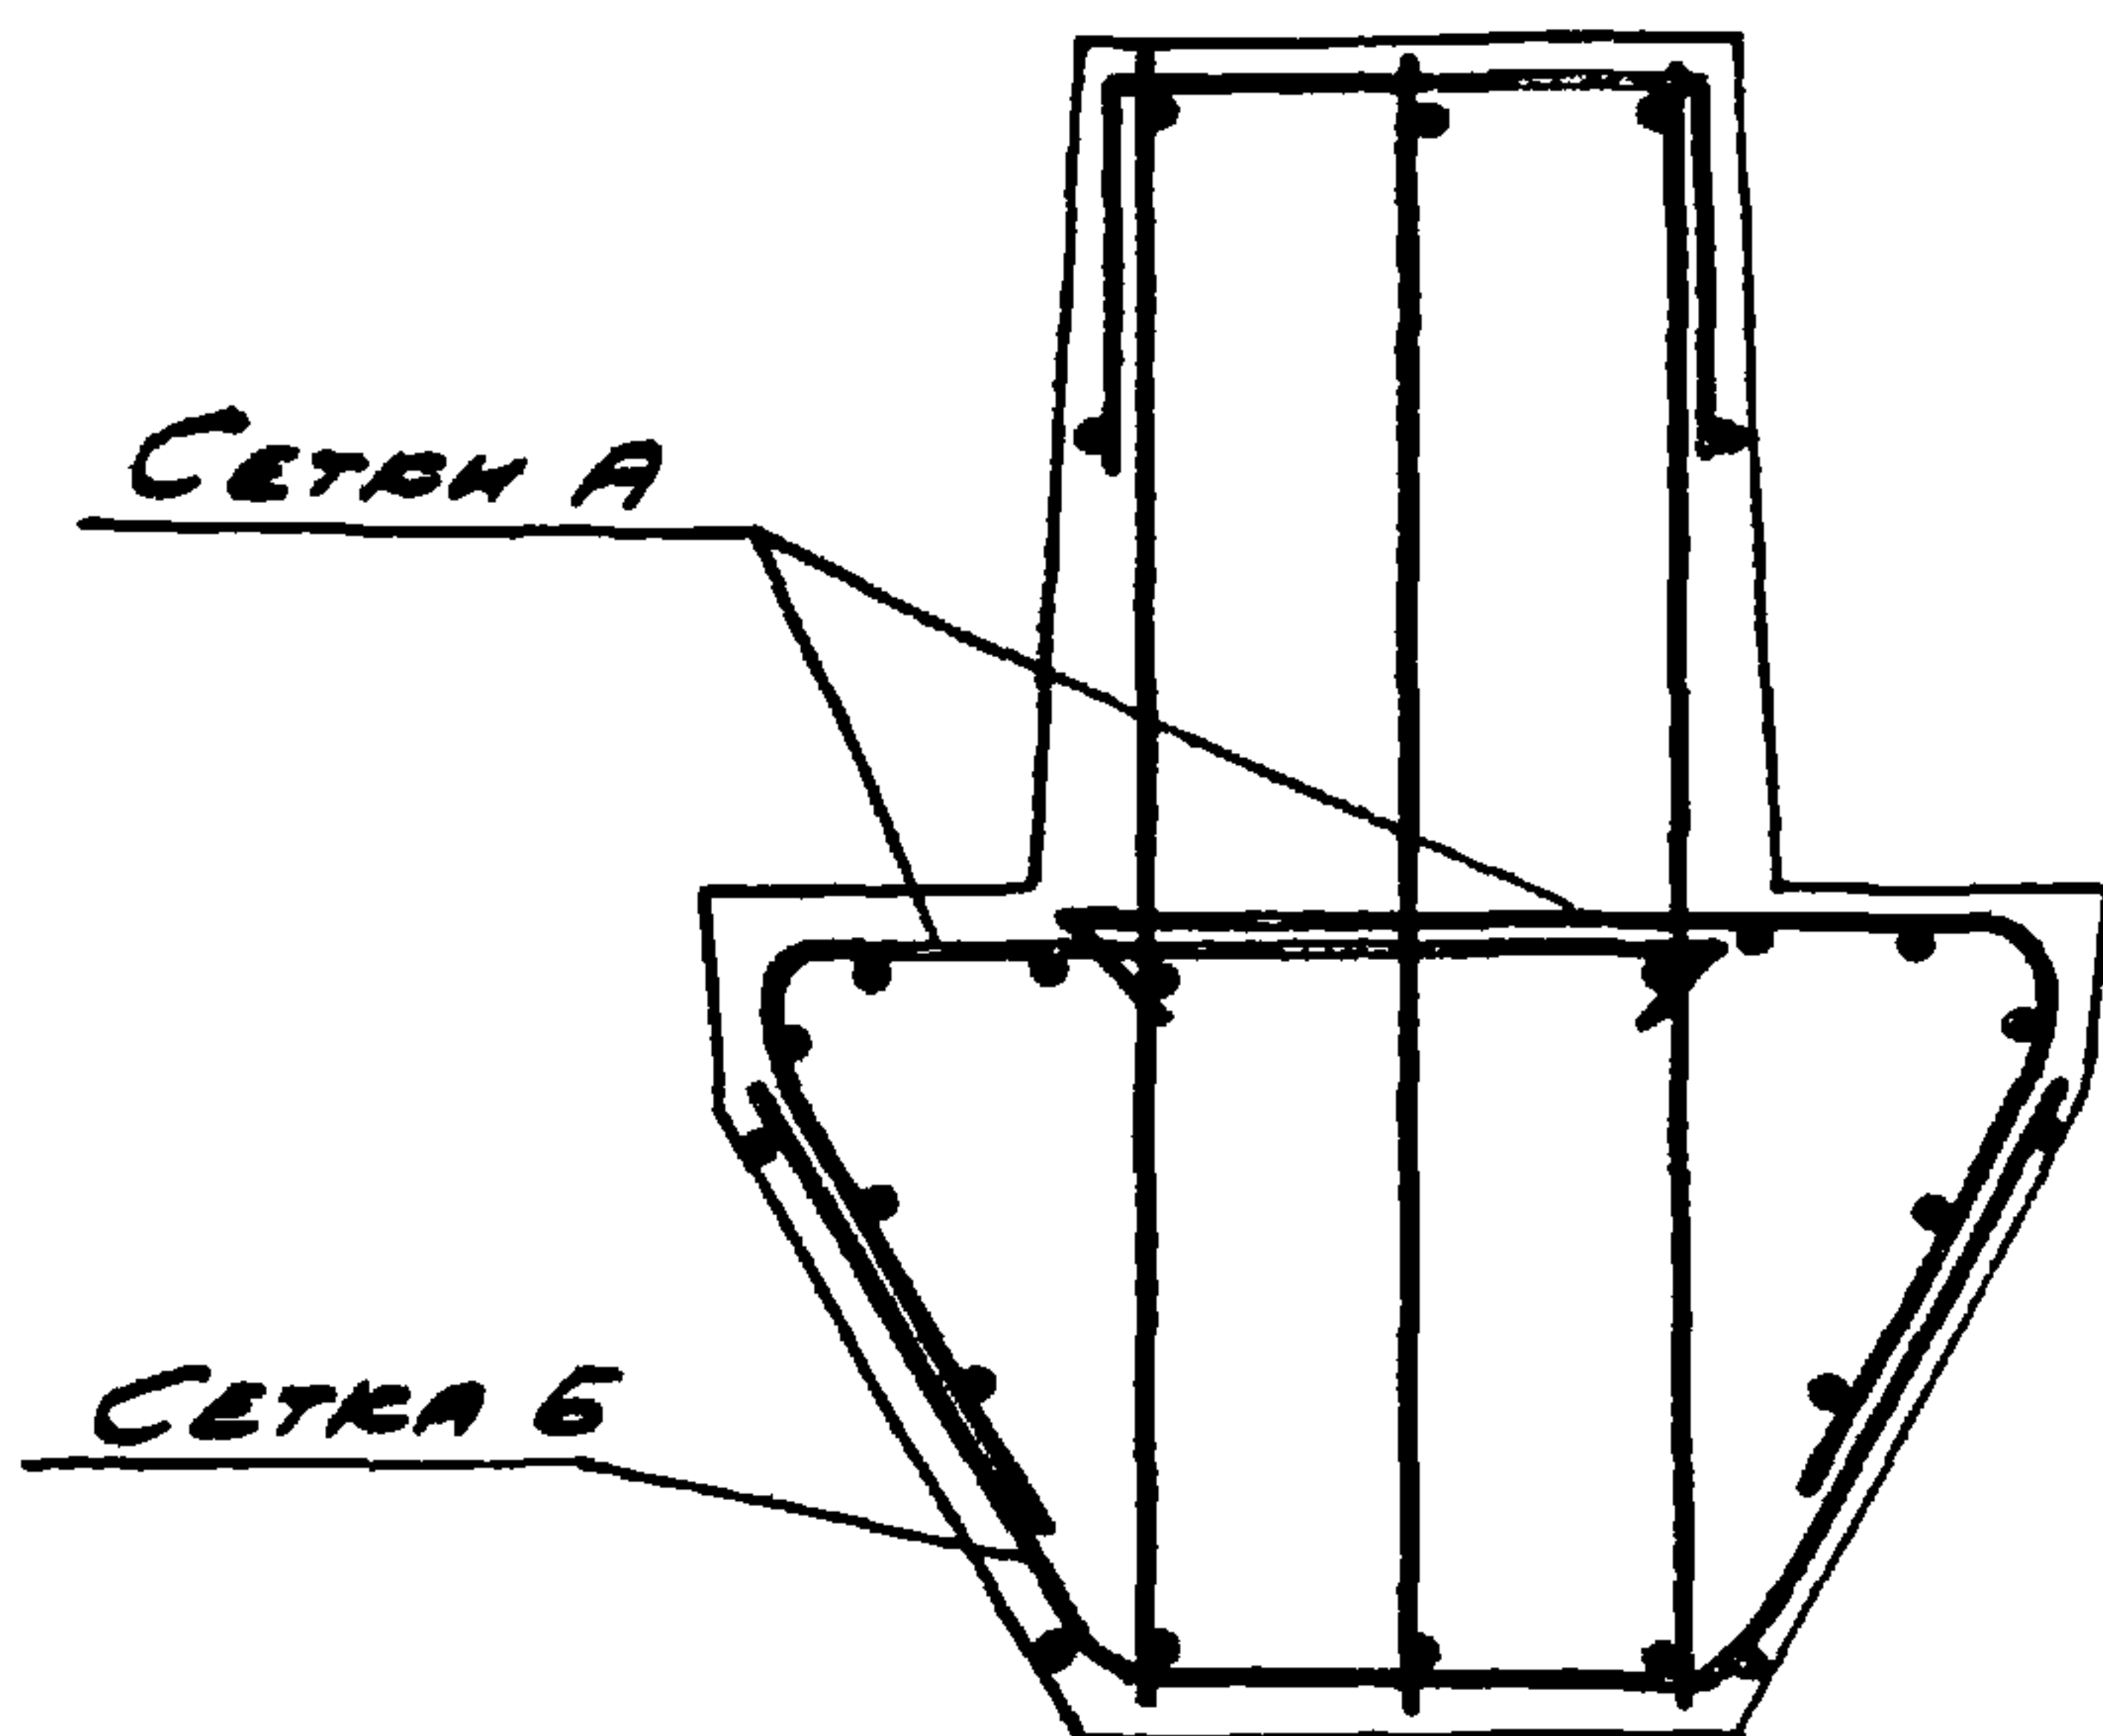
Армирование ригелей при электротермическом способе натяжения арматуры
